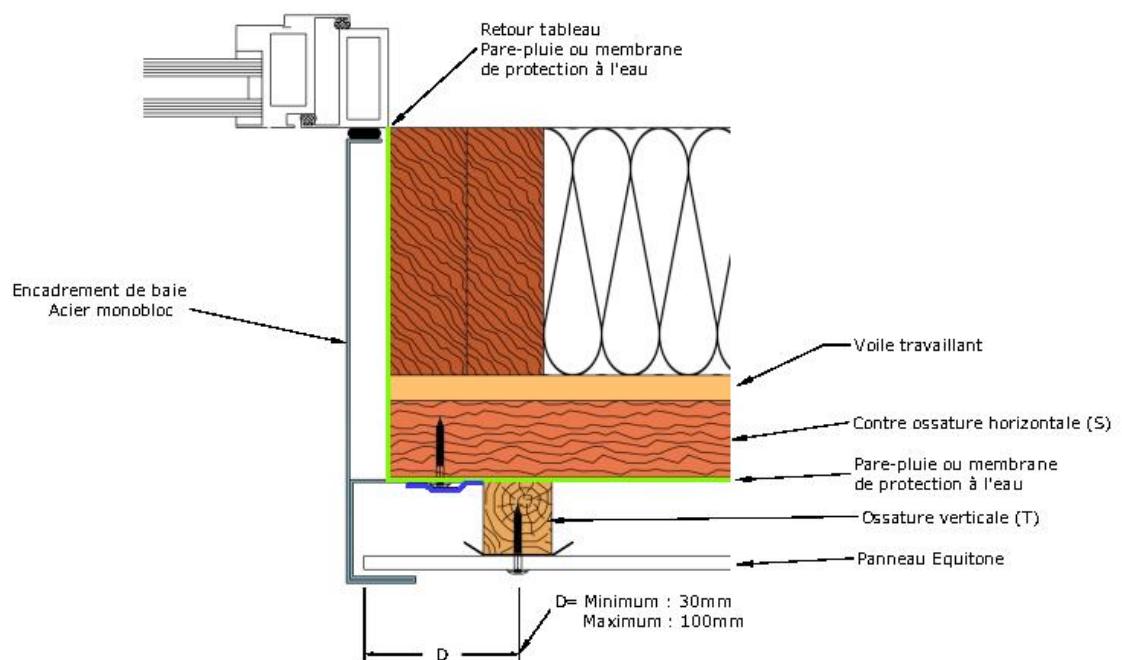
Encadrement de baie Ee2, acier 15/10^e monobloc soudé 4 cotés, bardage sur FOB avec contre-ossature (S), coupe horizontale
